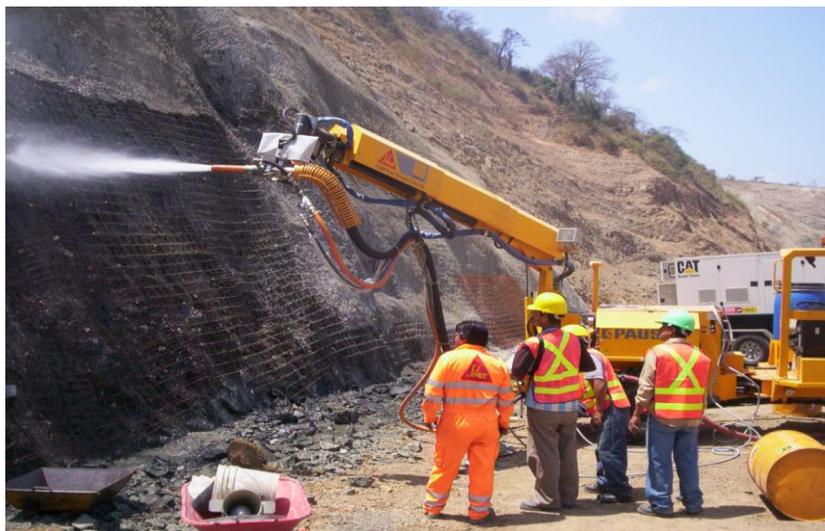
Malla Electro soldada y Hormigón lanzado.
